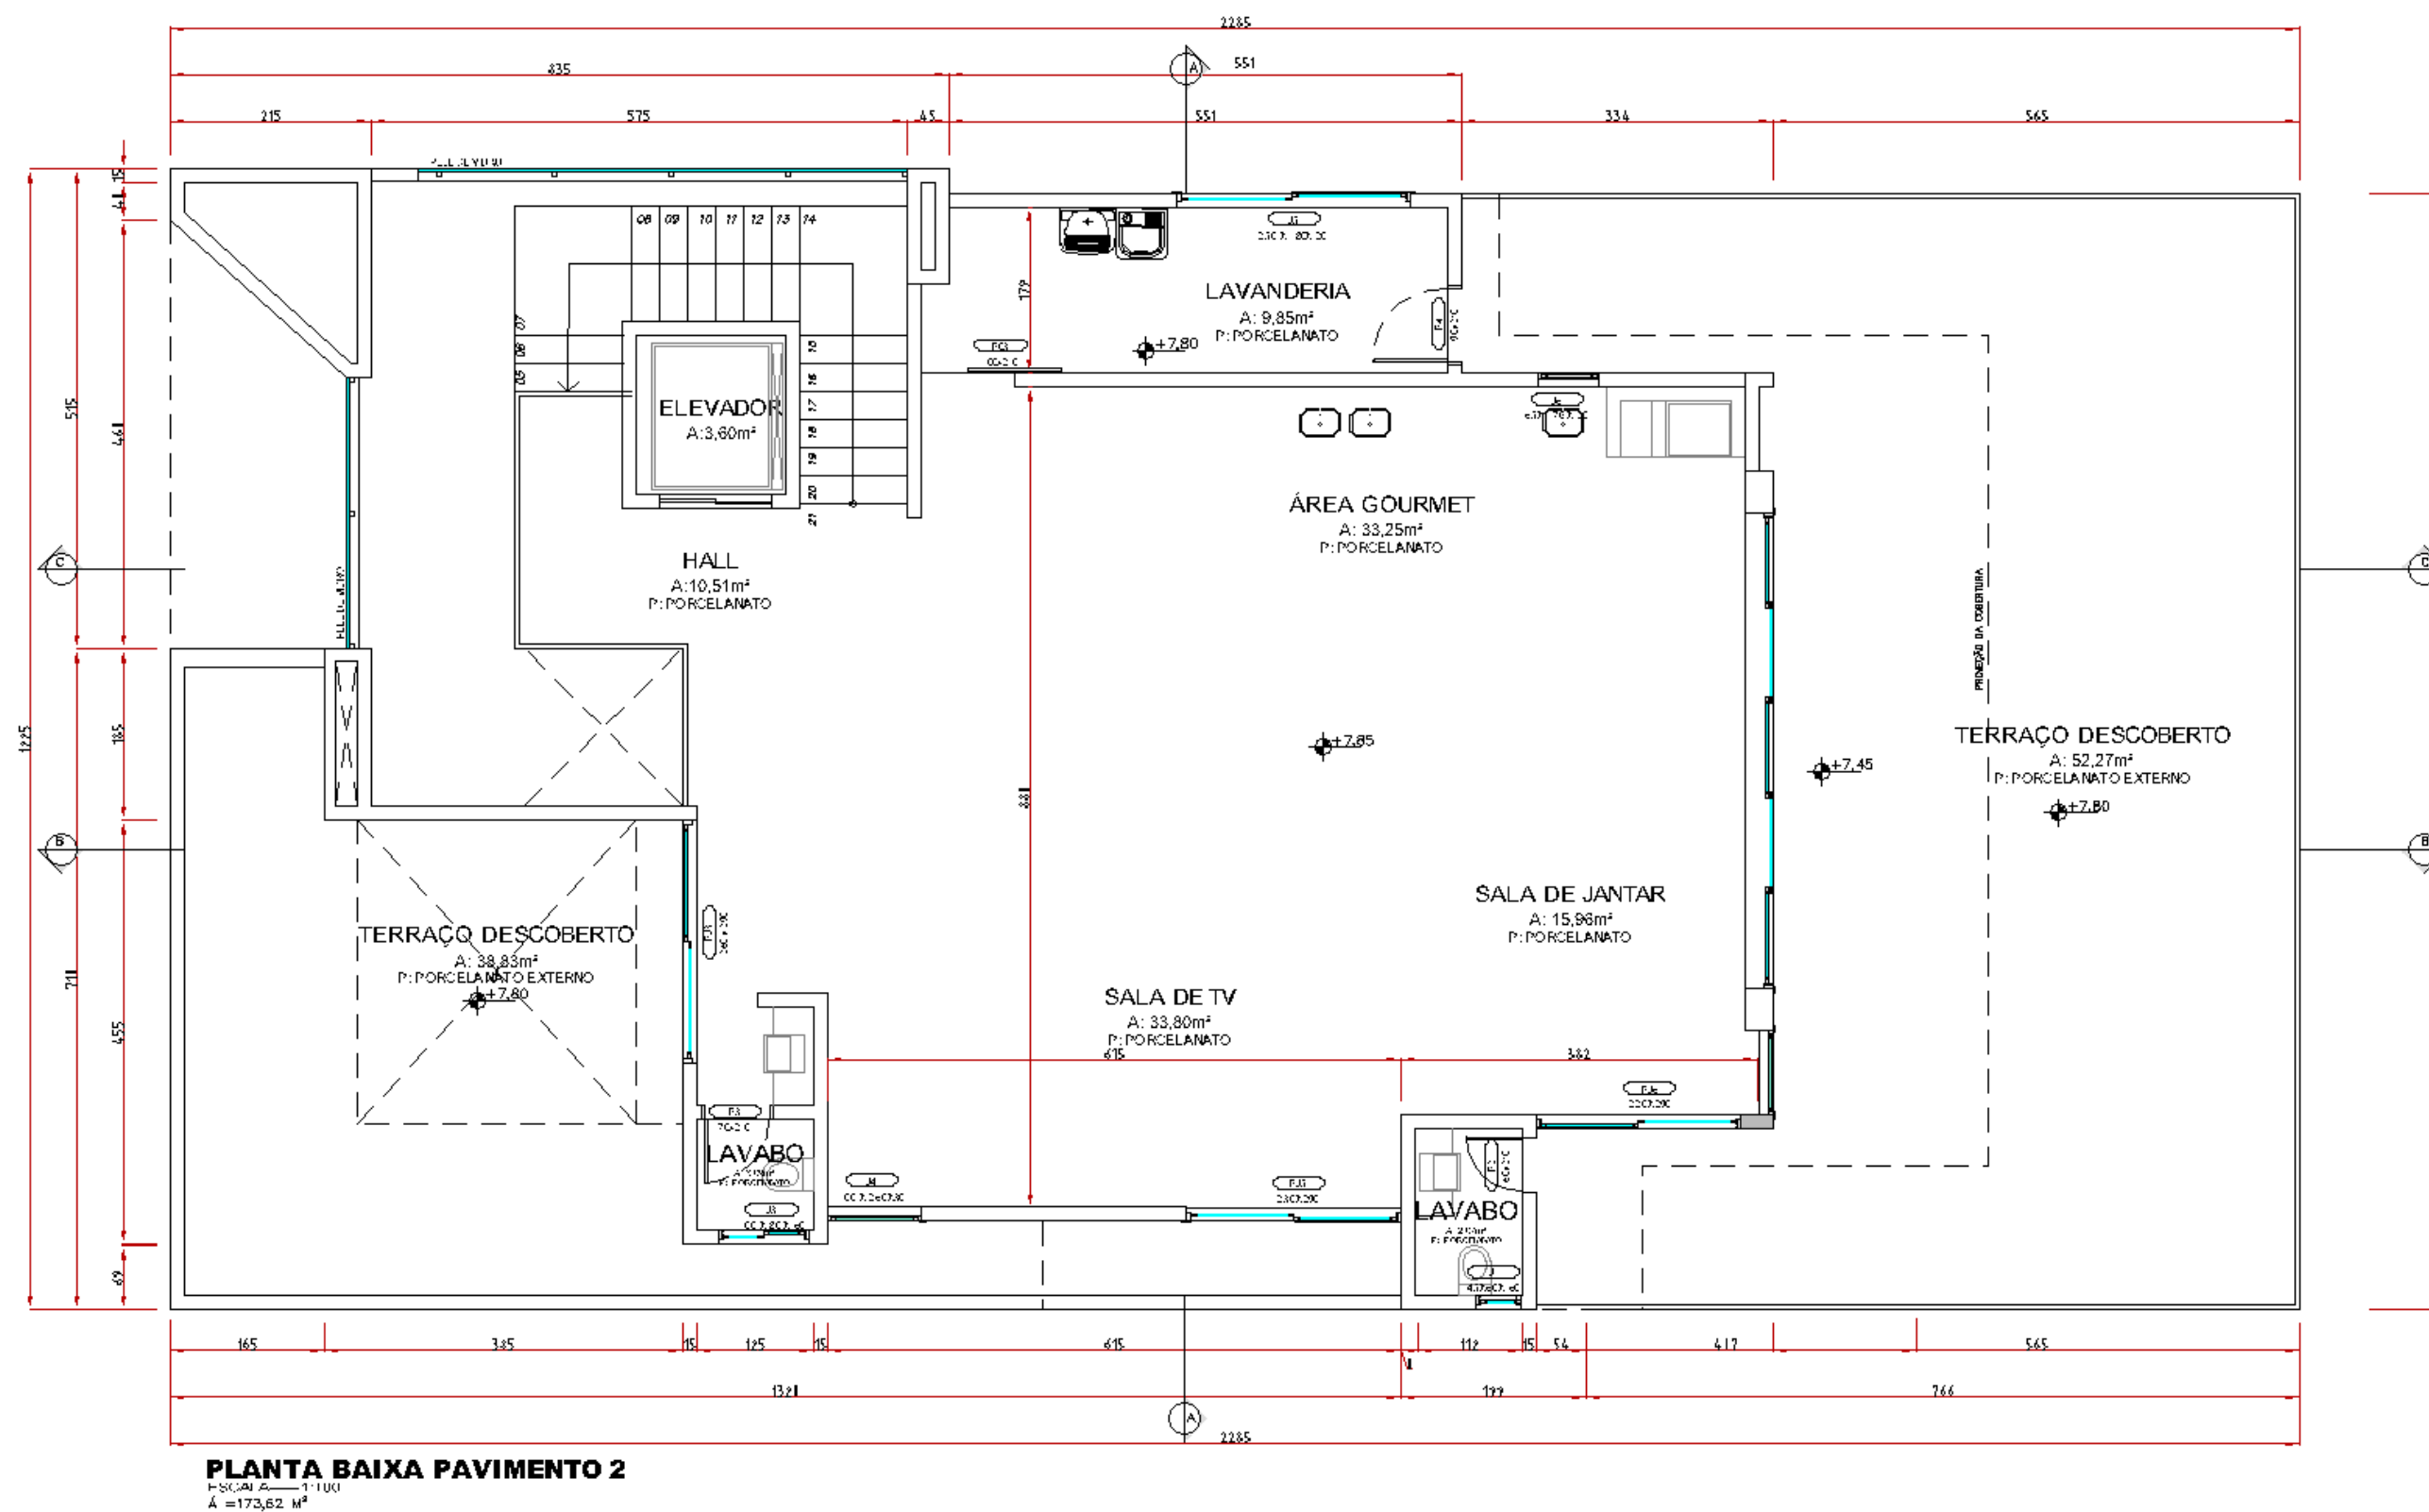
Planta Baixa 2º Pavimento. Fonte: Autor
